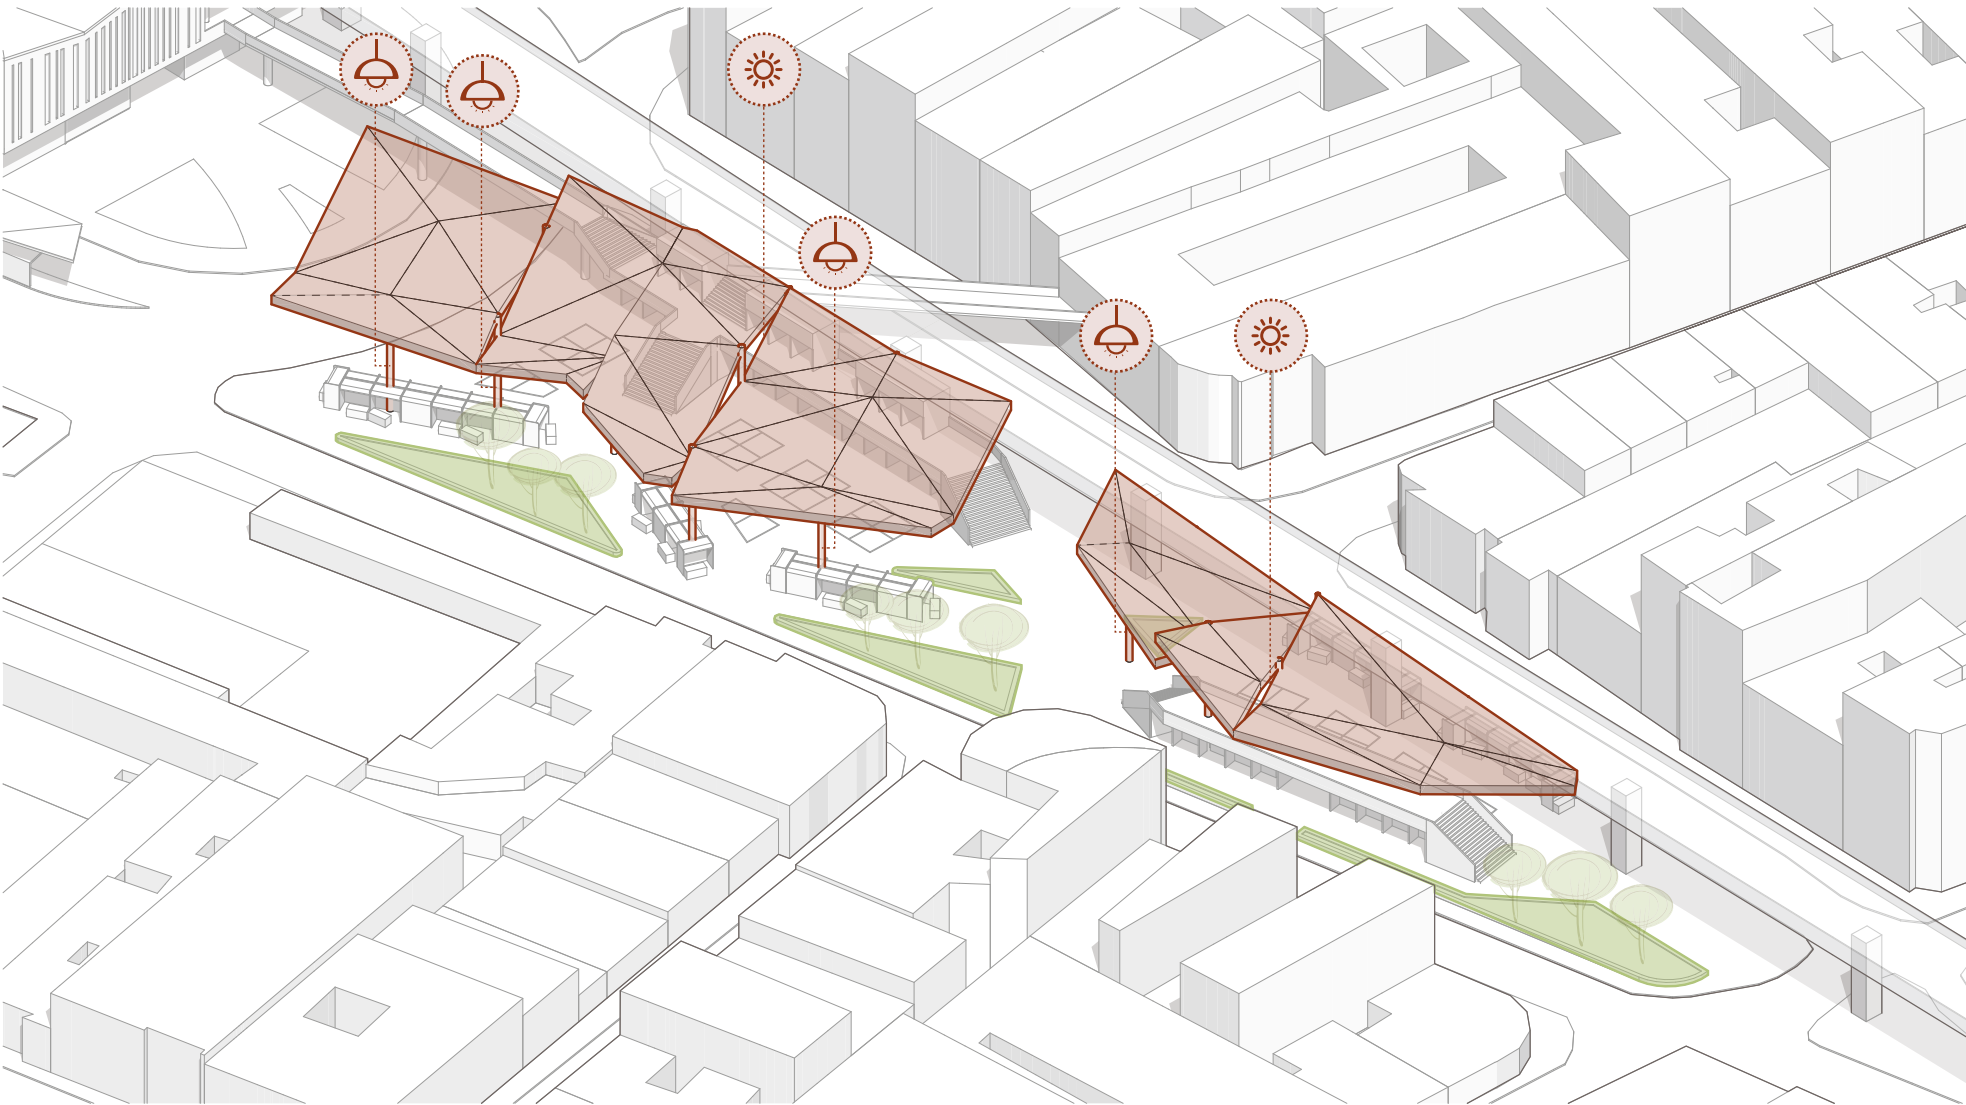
„Mercado Punta Nueva“ - Dachstruktur und Beleuchtungselemente
